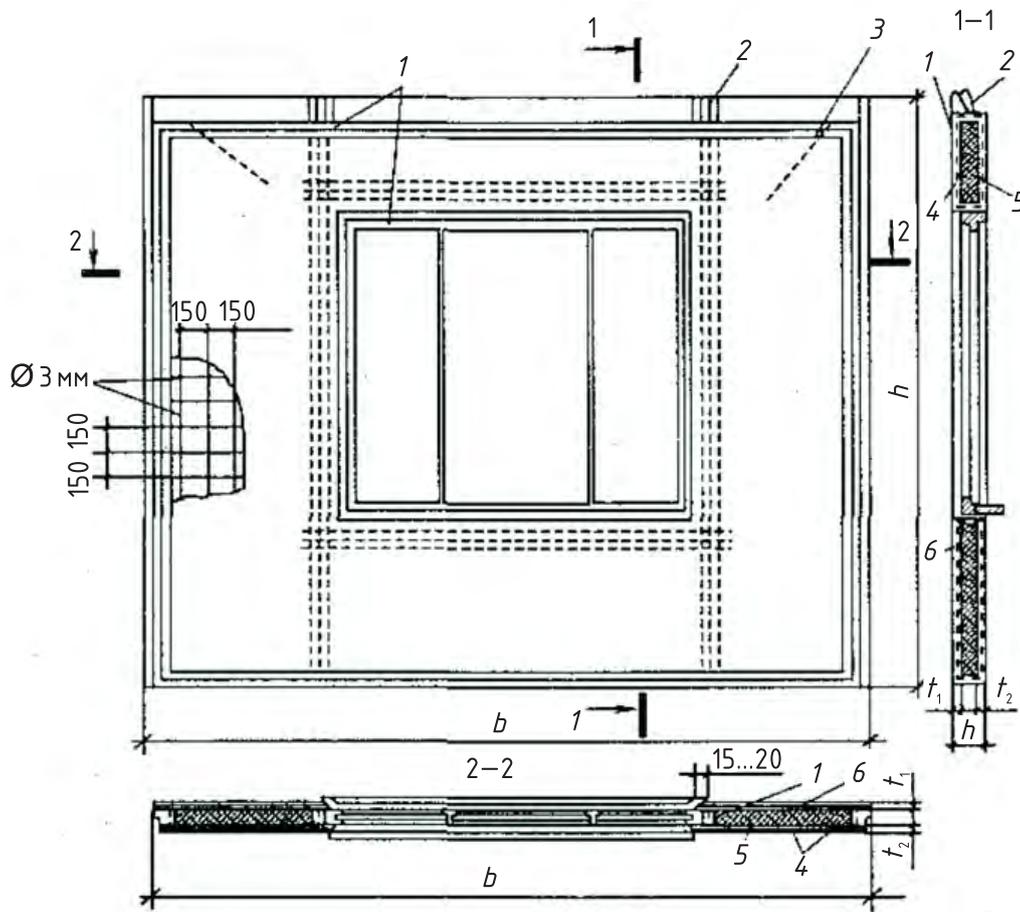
Трехслойная стеновая панель: 1 — сварные каркасы, покрытые бетоном; 2 — монтажные петли; 3 — закладные детали; 4 — арматурные сетки; 5 — утеплитель; 6 — тяжелый бетон
